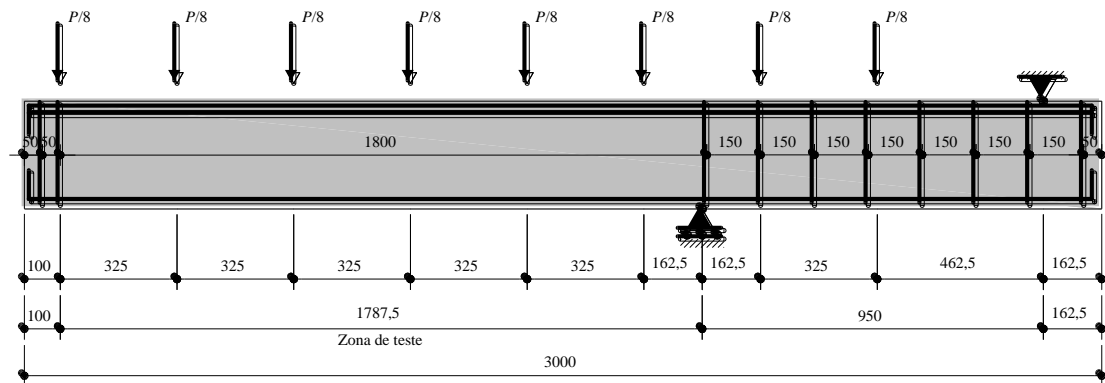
Arranjo dos reforços das vigas B15H30CF75 e B11H40CF60 (cotas em mm).
